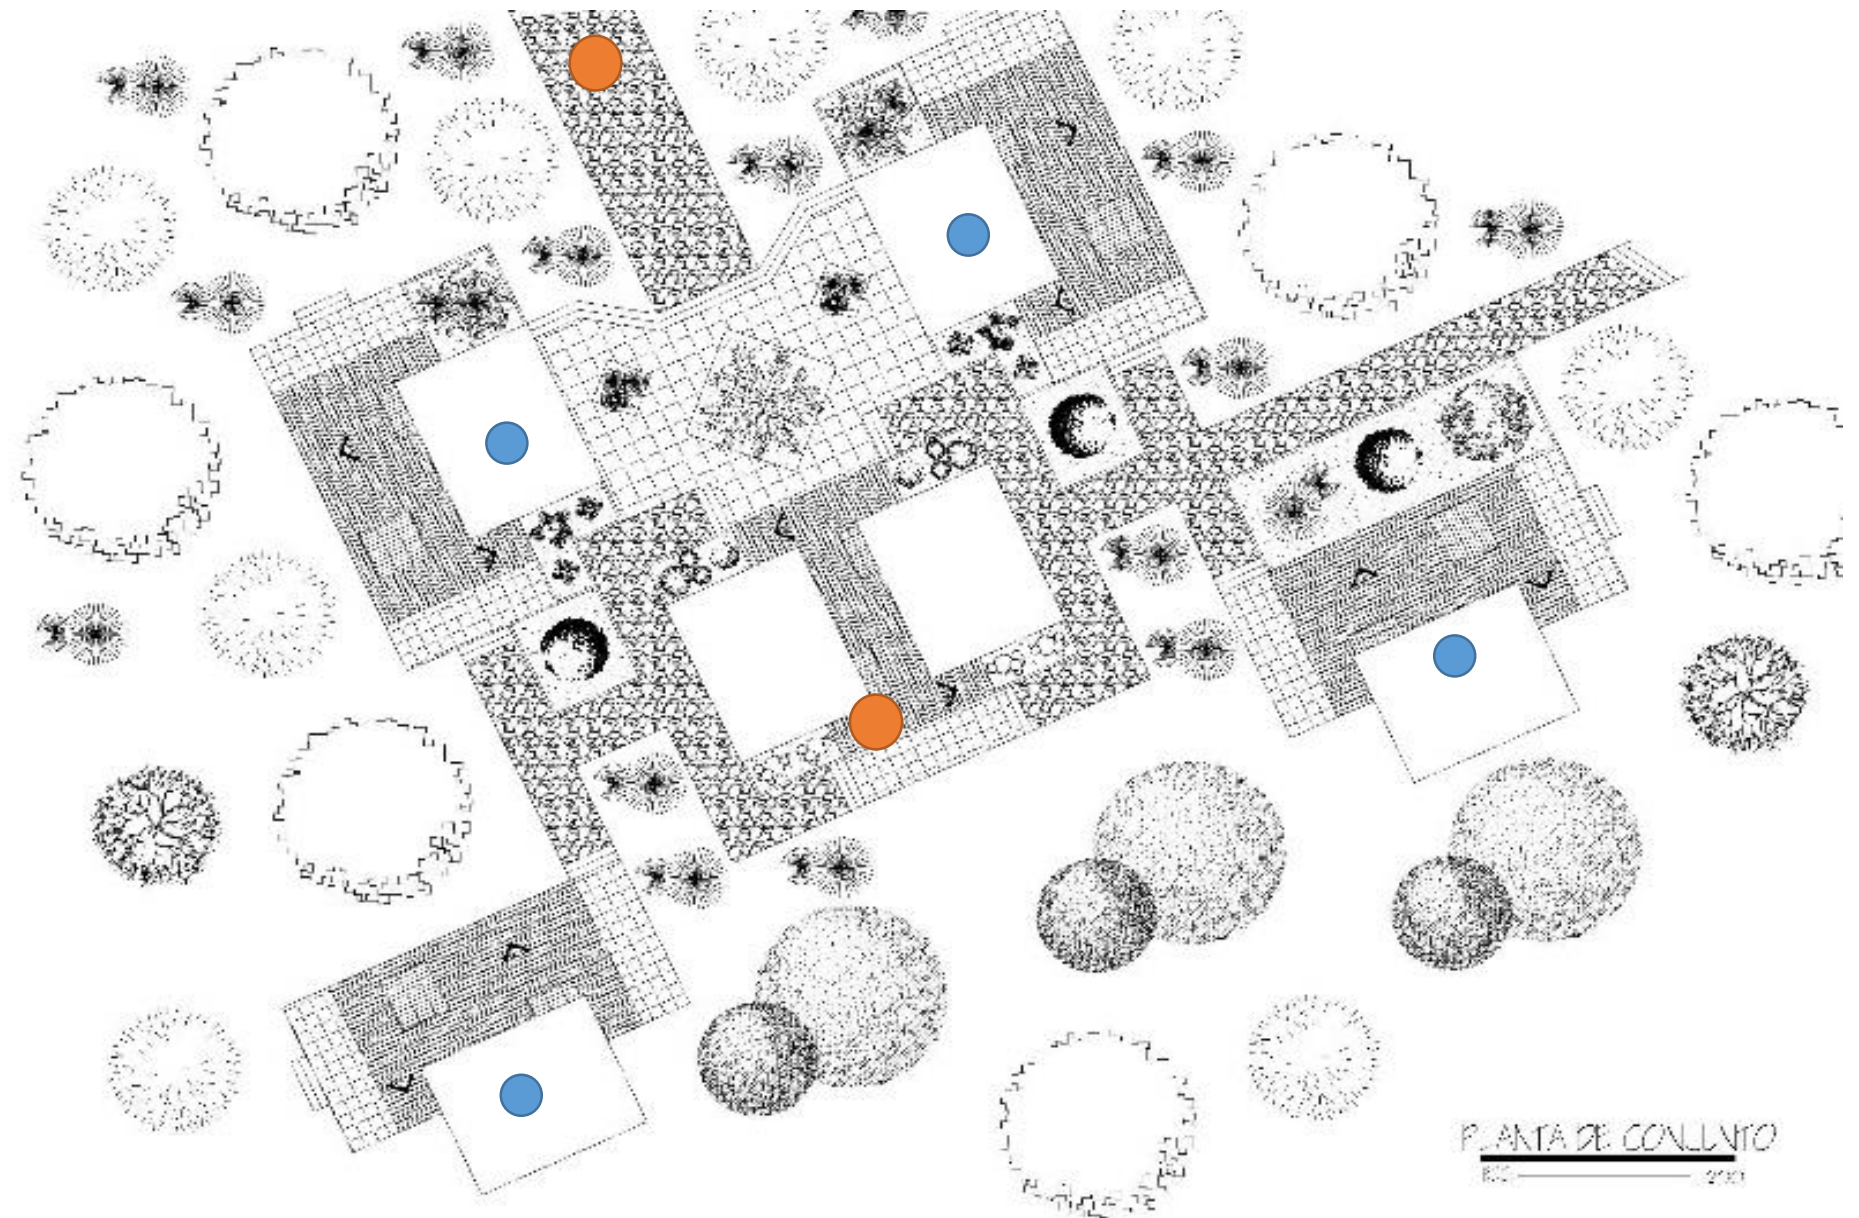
Planta de Conjunto Aldea Mama Laly. Finca Las Delicias
